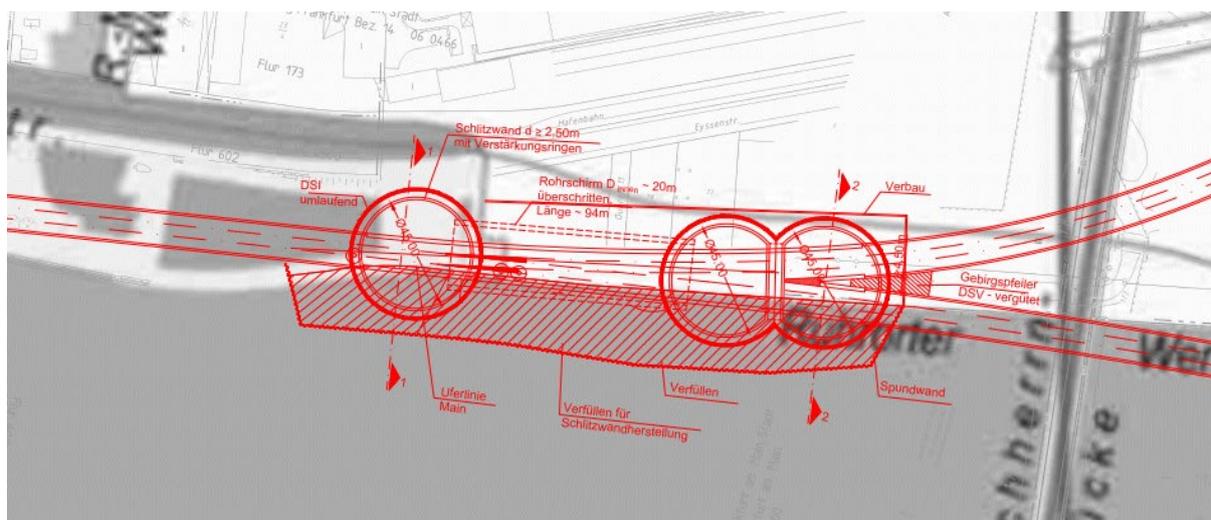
Mögliche Lage und Grundriss Y-Bauwerk, 2gleisige Tunnelröhre
